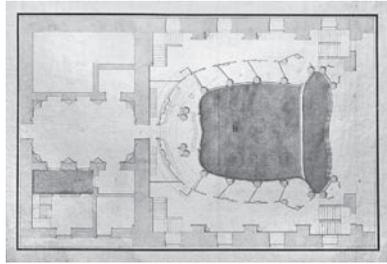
MNAA, Inv. 1670, Planta do Teatro de Salvaterra.
